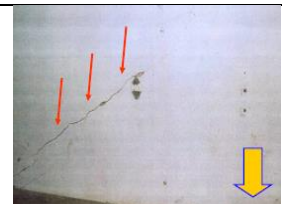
Fissura diagonal devido a assentamento (BRANCO & BRITO, 2005)
